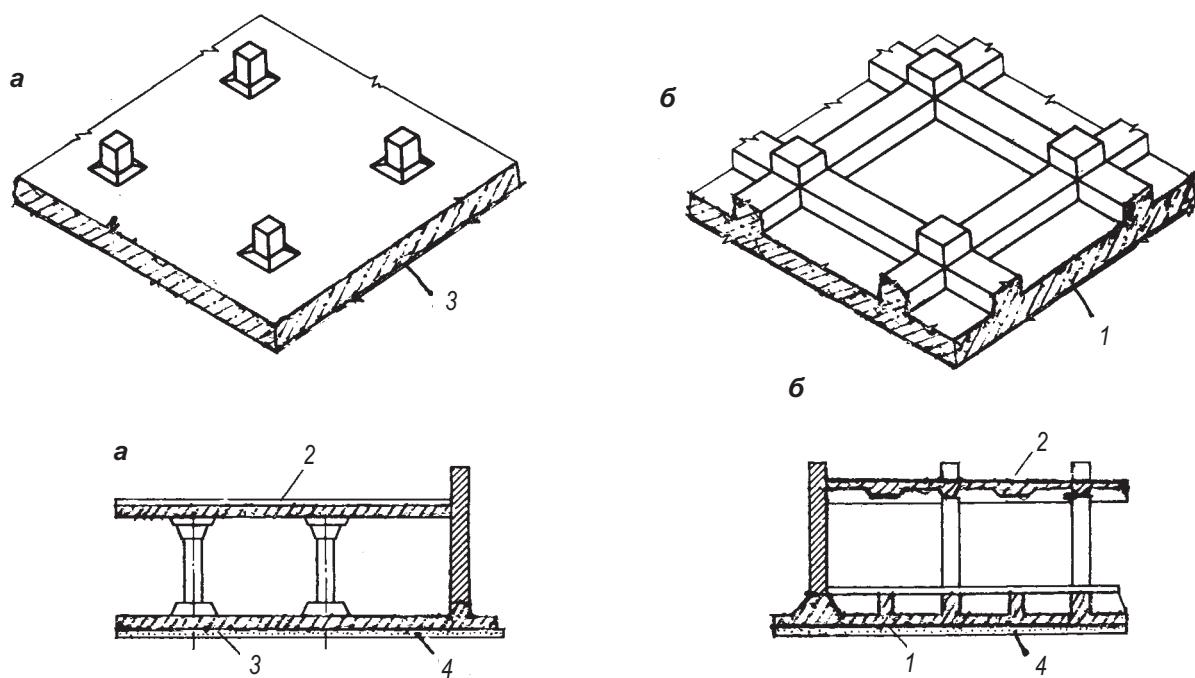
Суцільні фундаменти з монолітних залізобетонних плит в плані та в розрізі:
